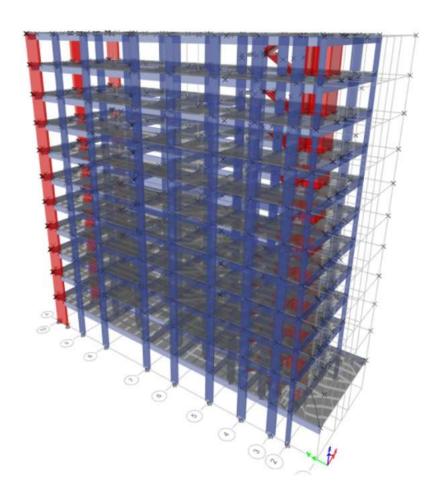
Modelo de estructuración de edificación de 10 pisos en 3D
